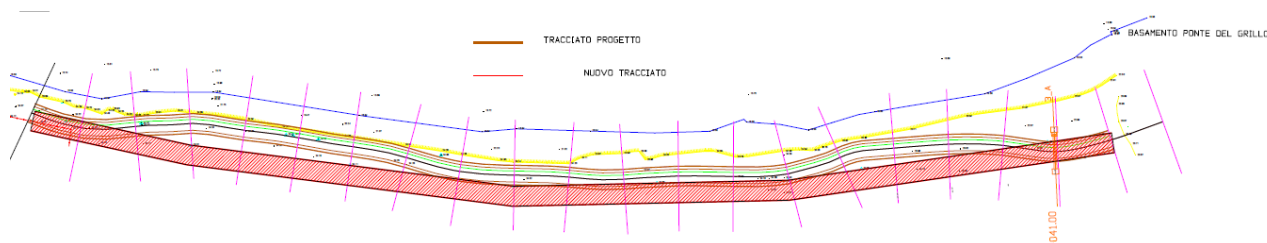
Raffronto tracciato di progetto-nuovo tracciato dalla sez.2 alla sez.20 bis
